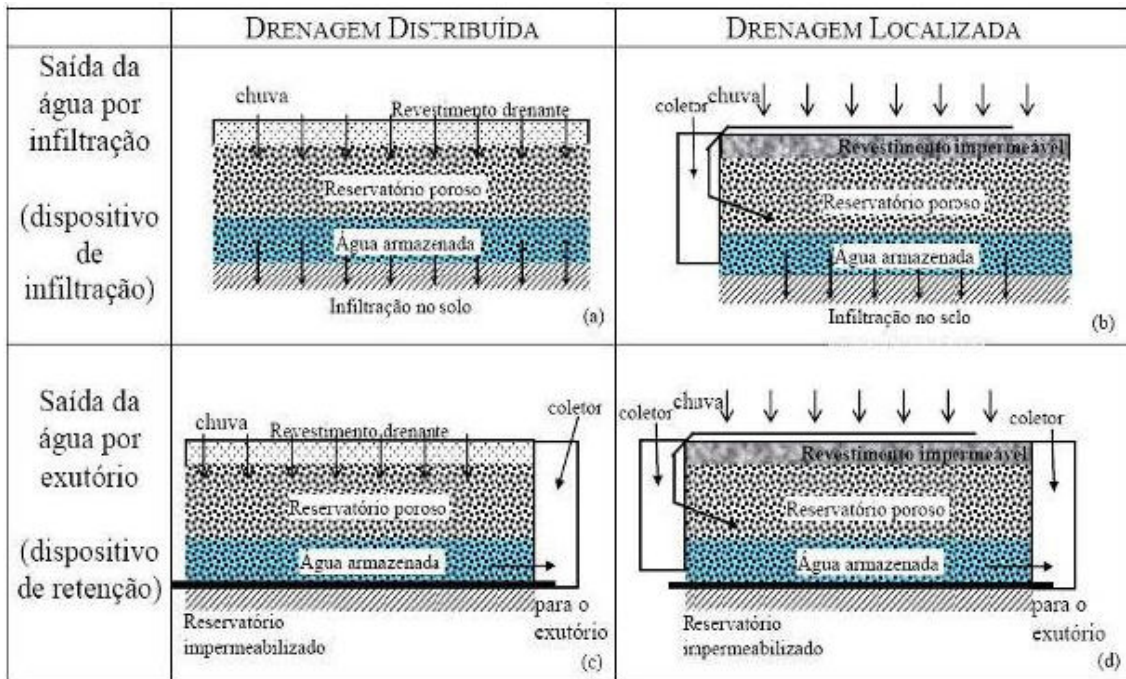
Ilustração dos diferentes tipos de pavimento. Fonte: VIRGILIIS (2009).
